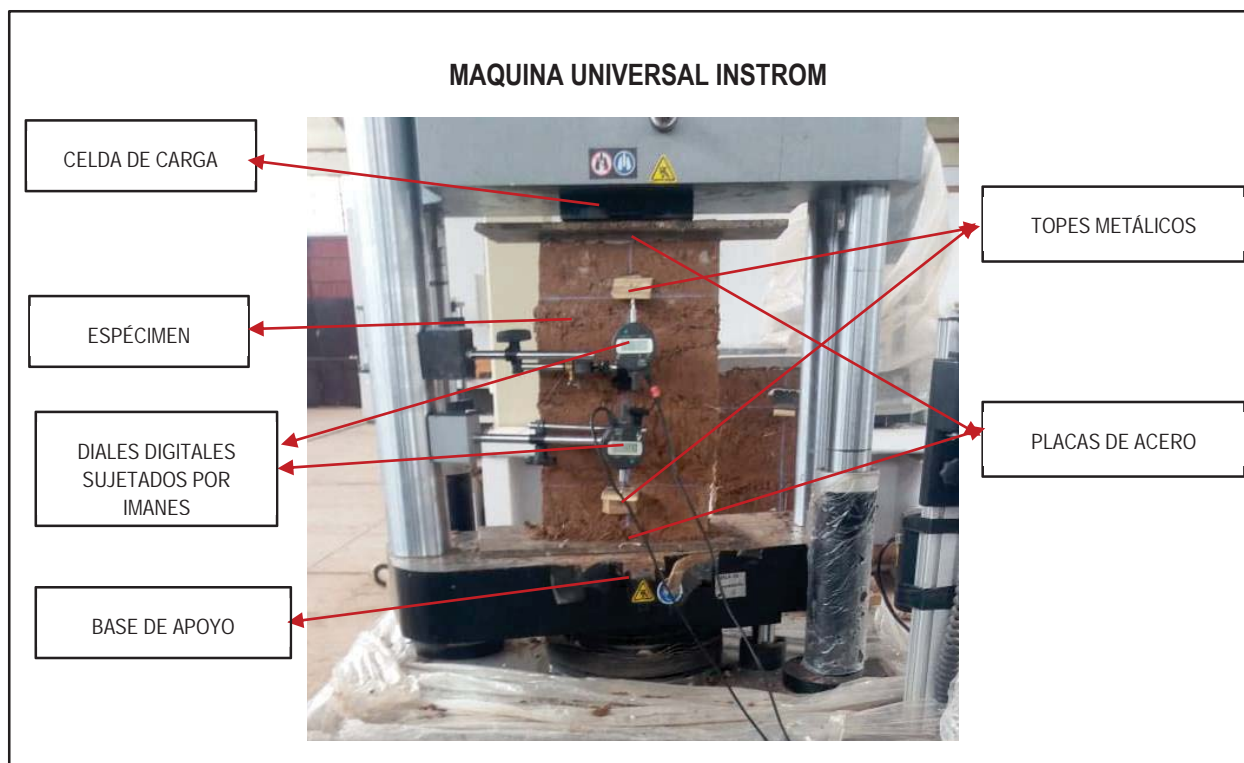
Instrumentación de pilas de adobe para ensayo de compresión axial.
